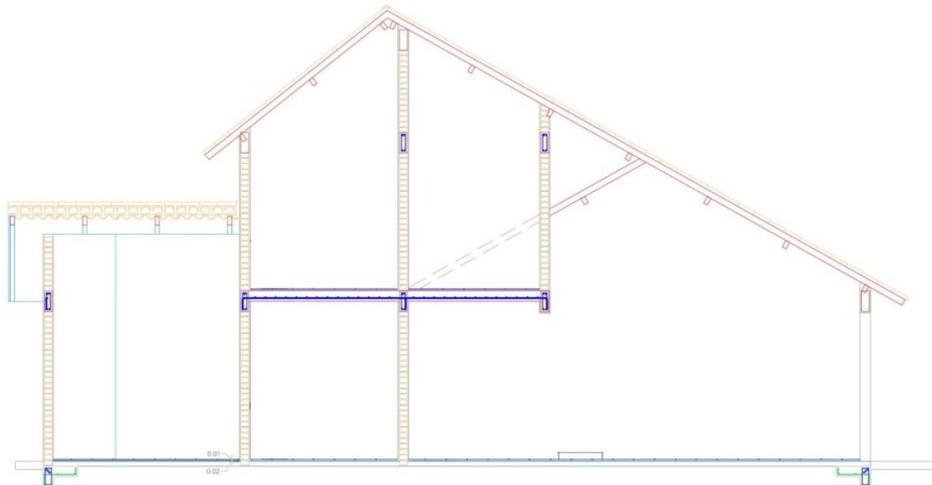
Ubicación de las Vigas de Madera. Vista Frontal
